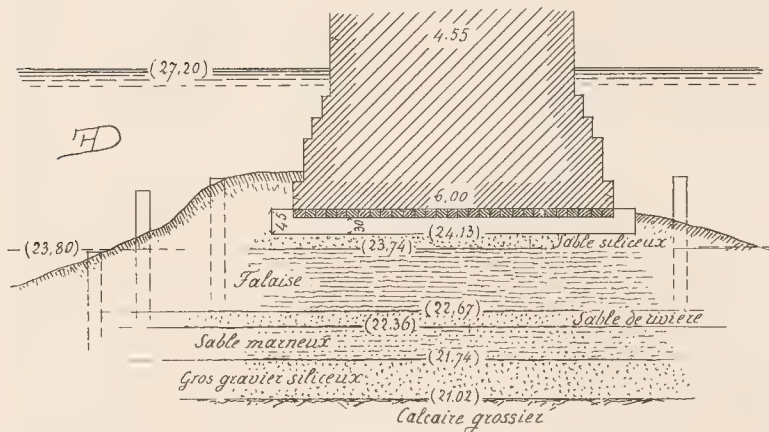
Grand Bras; fondation de la 2<sup>e</sup> pile de rive gauche.
